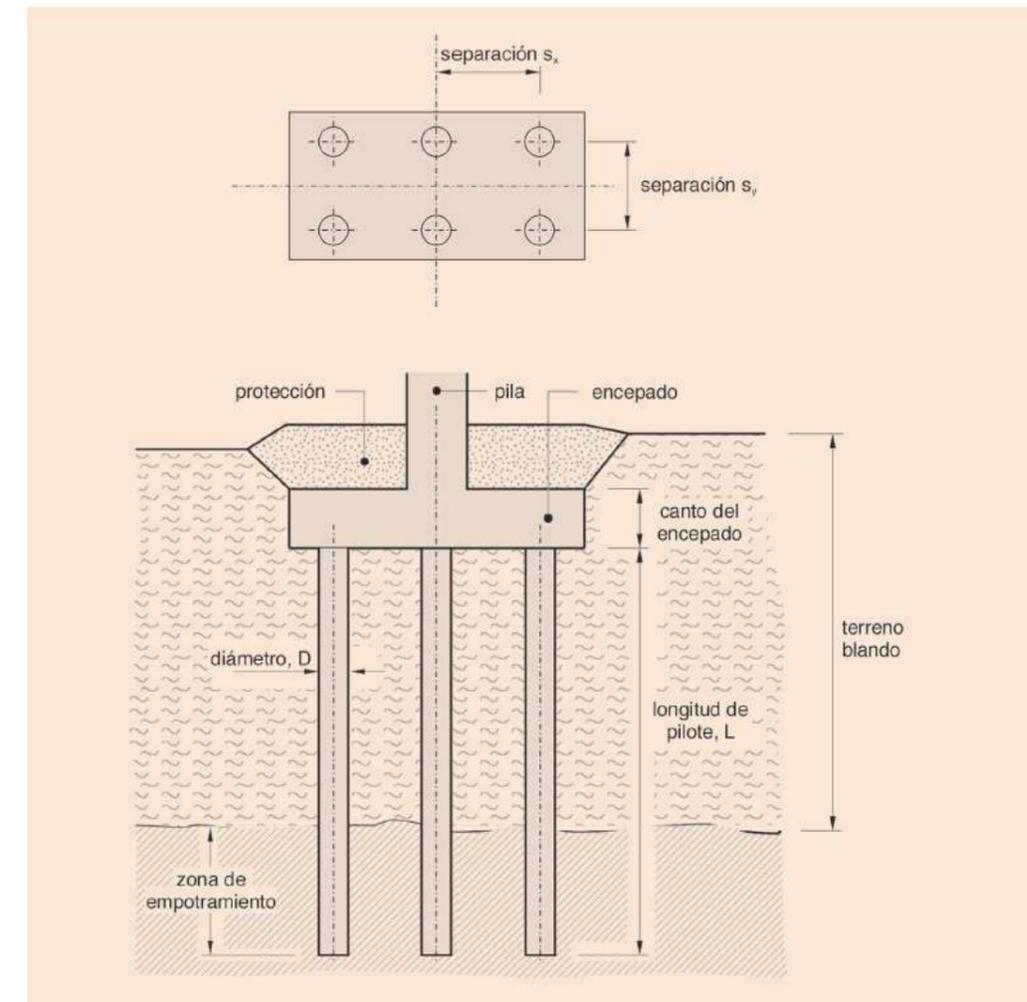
Ilustración de ejemplo de cimentación profunda. Fuente: Guía de cimentaciones en obras de carretera
